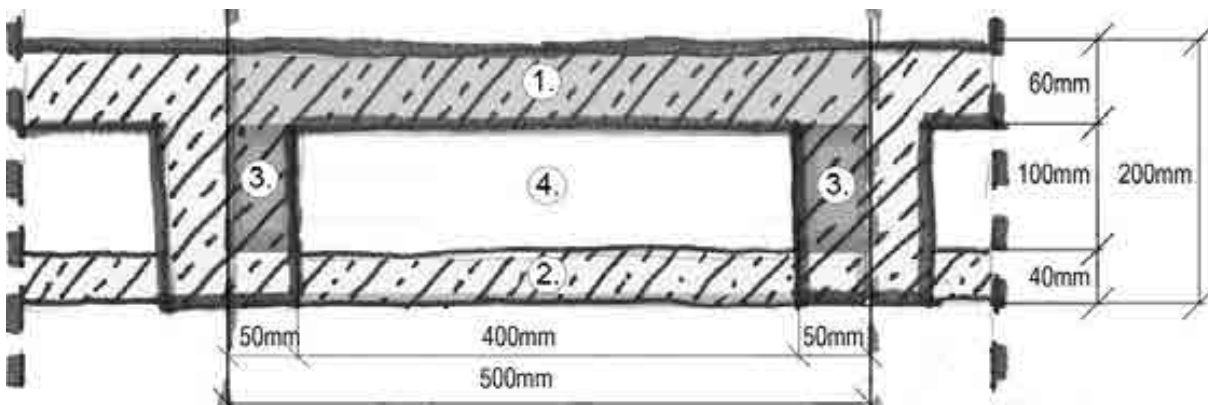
Probenabschnitt Hohlraumdecke Bestand\_20cm\_6cm
